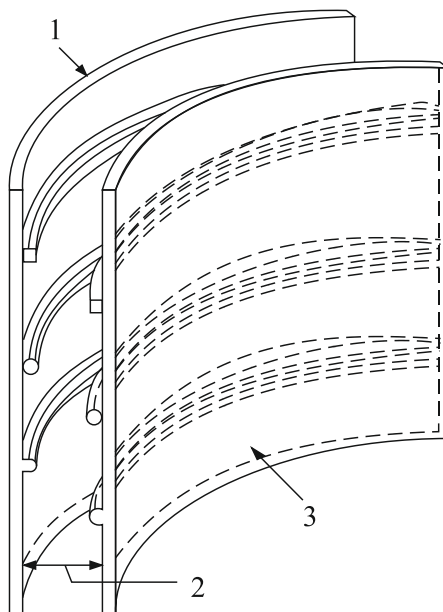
Пример поперечных сечений трубобетонных мостовых опор, армированных жесткой арматурой [2]
